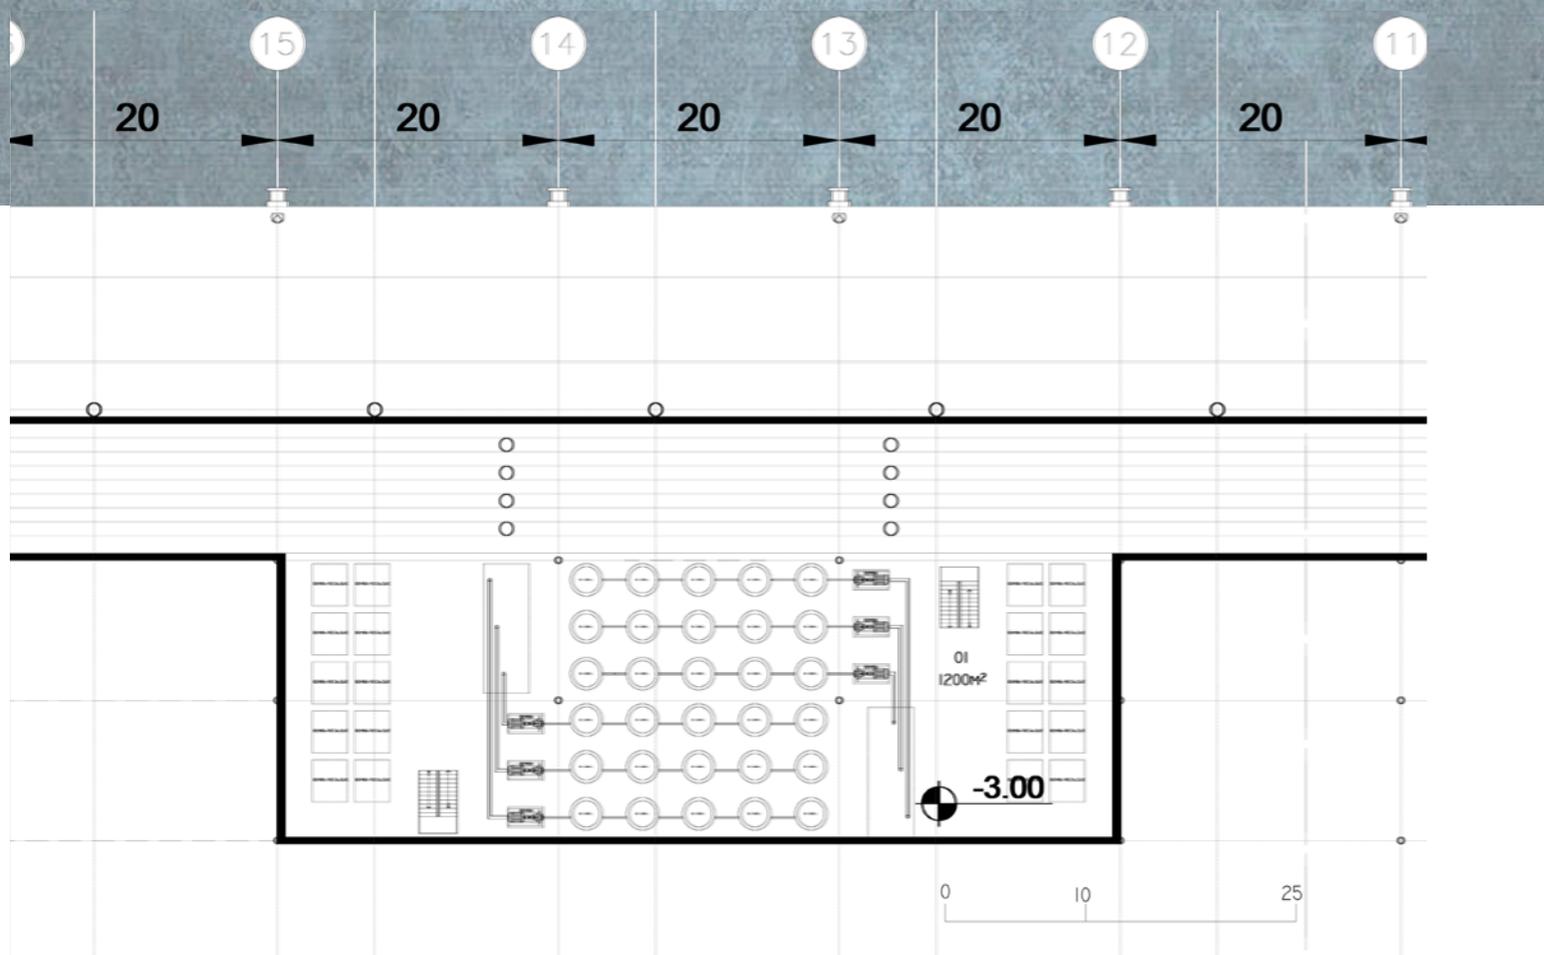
Planta do Primeiro pavimento. Fonte: Autoria própria.
